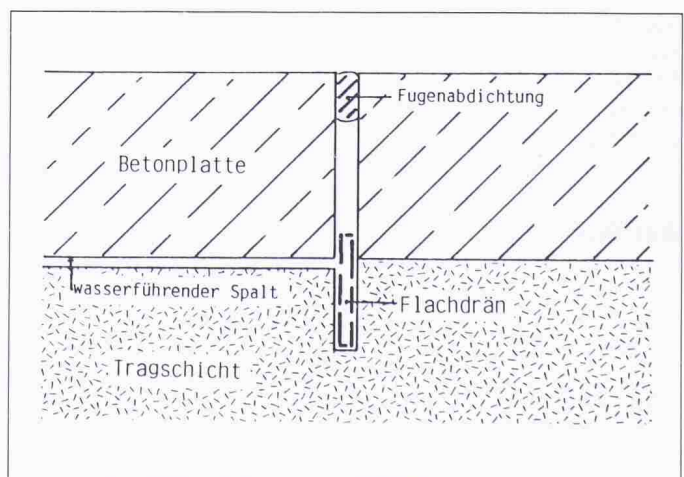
Entwässerung einer Betonfahrbahnplatte durch nachträglichen Einbau von geotextilen Flachdräns. Schnitt durch den Entwässerungsschlitz mit Flachdrän (Wilwers)
